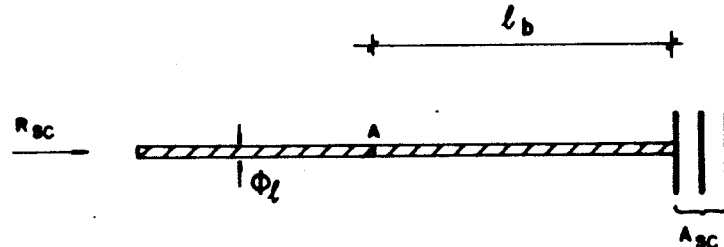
Armadura transversal nas ancoragens - barra comprimida.
